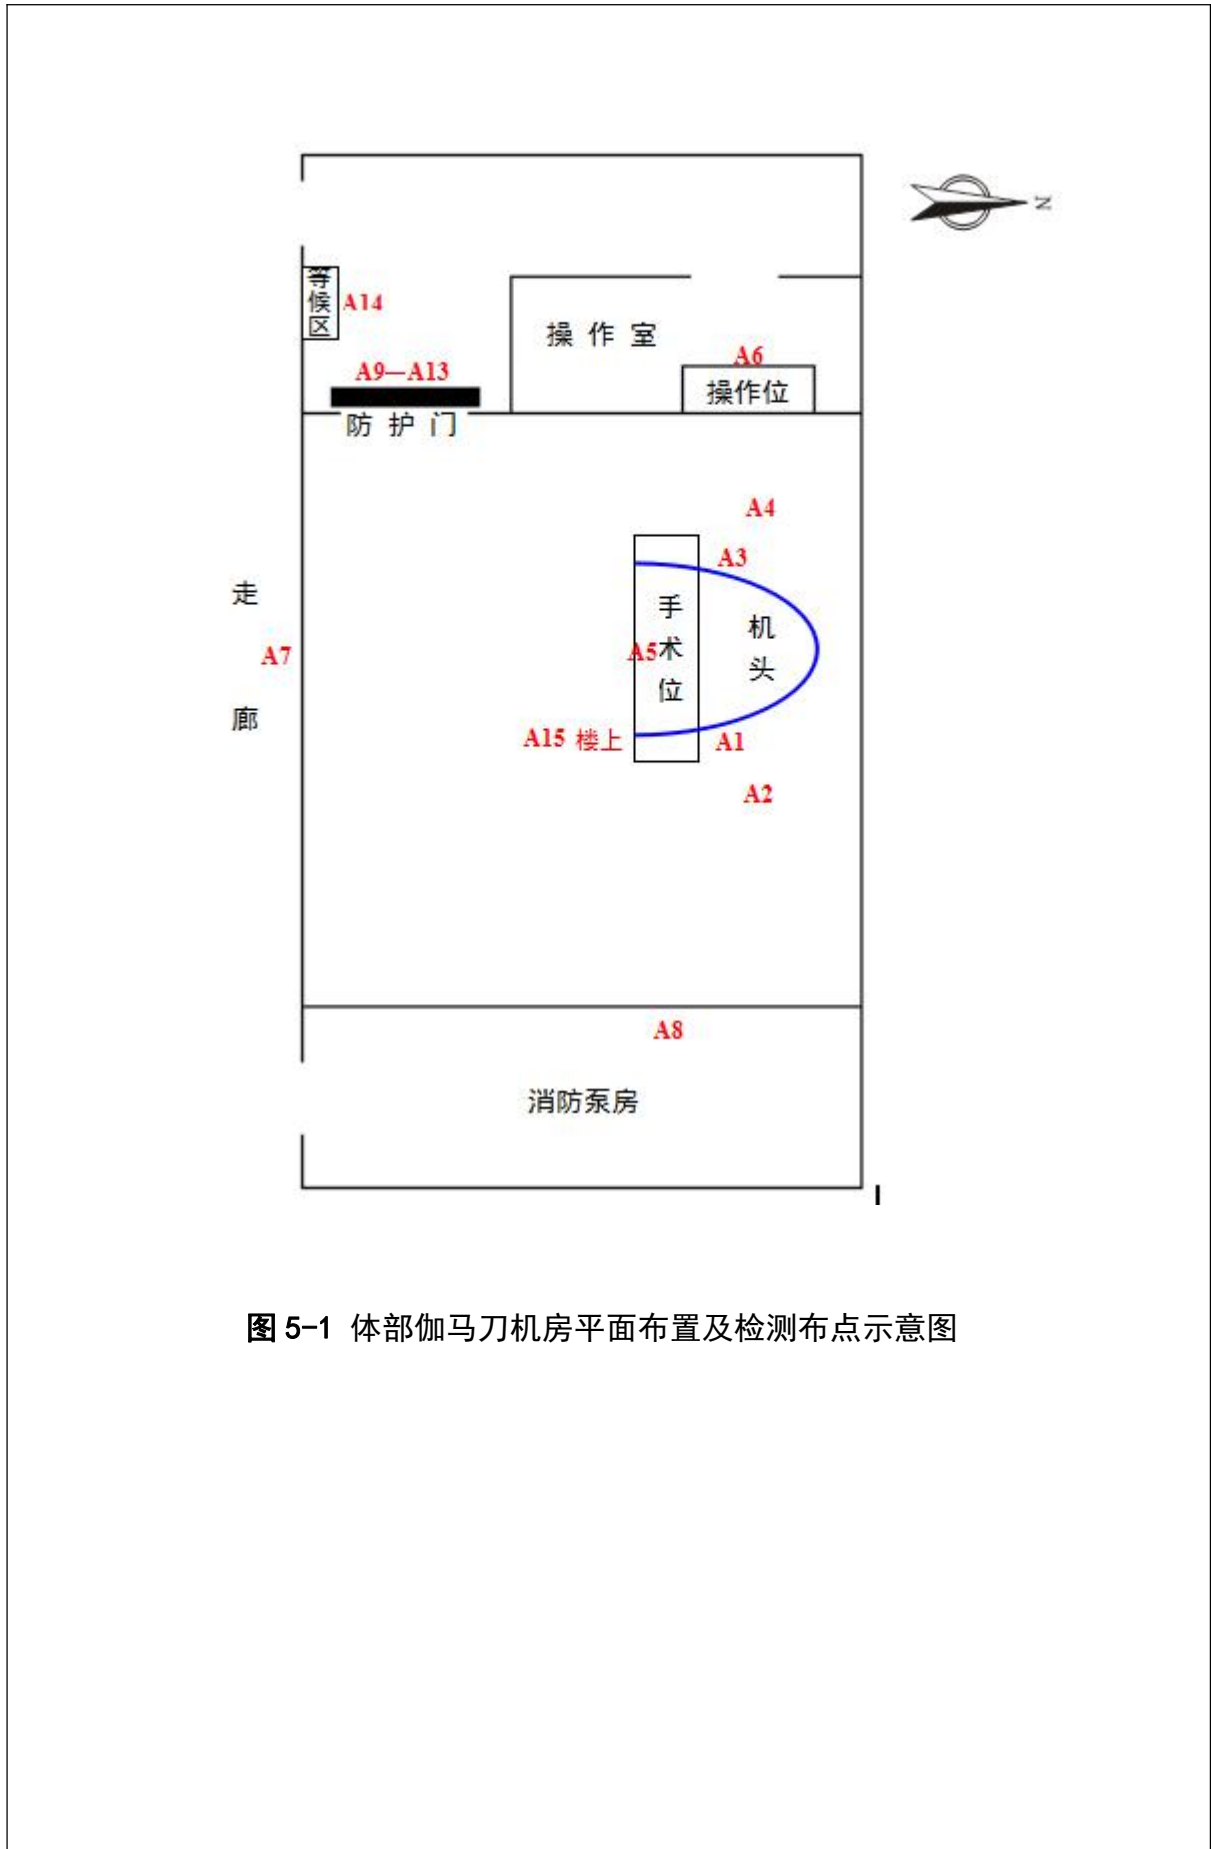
体部伽马刀机房平面布置及检测布点示意图
